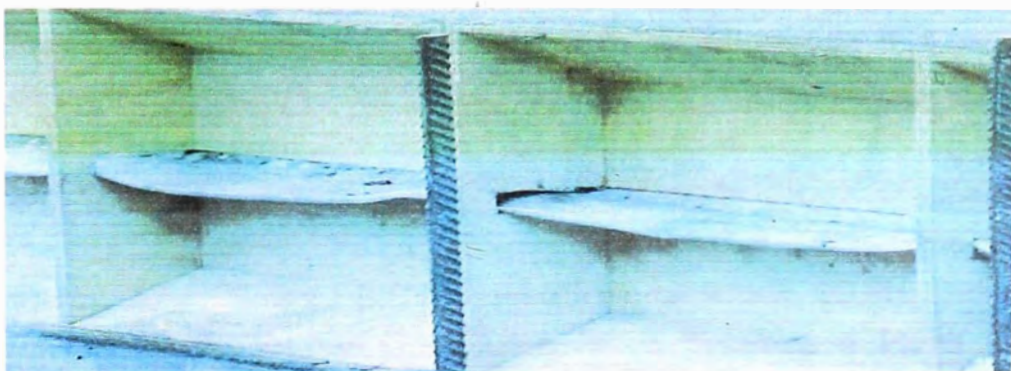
Water stop ampliado, elemento de junta colocados horizontalmente en la intersección de los muros con las losa de concreto, en la construcción del barrage.
